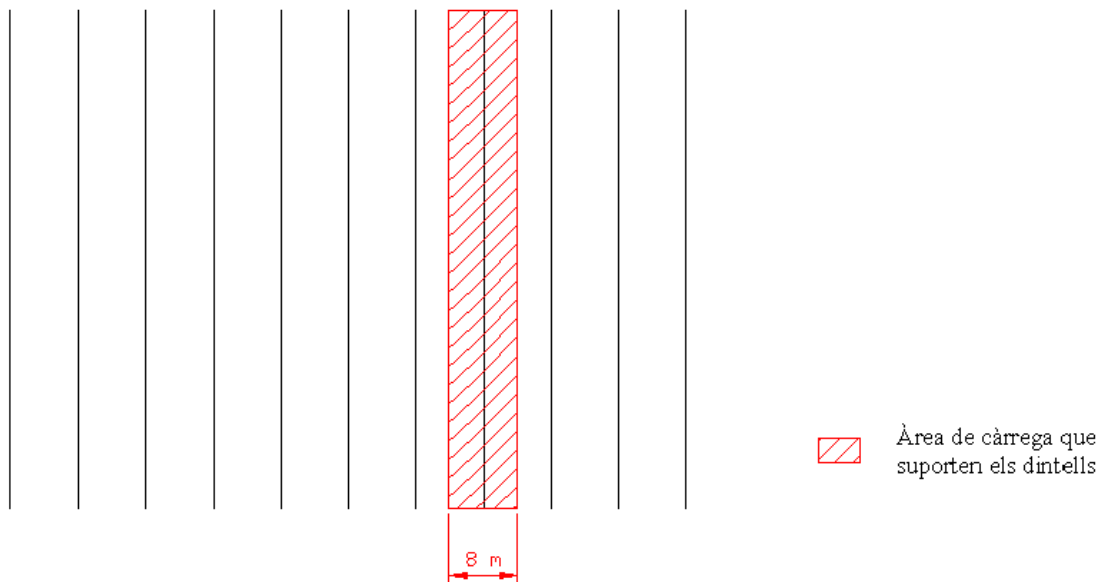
Vista en planta dels pòrtics (AutoCAD).
